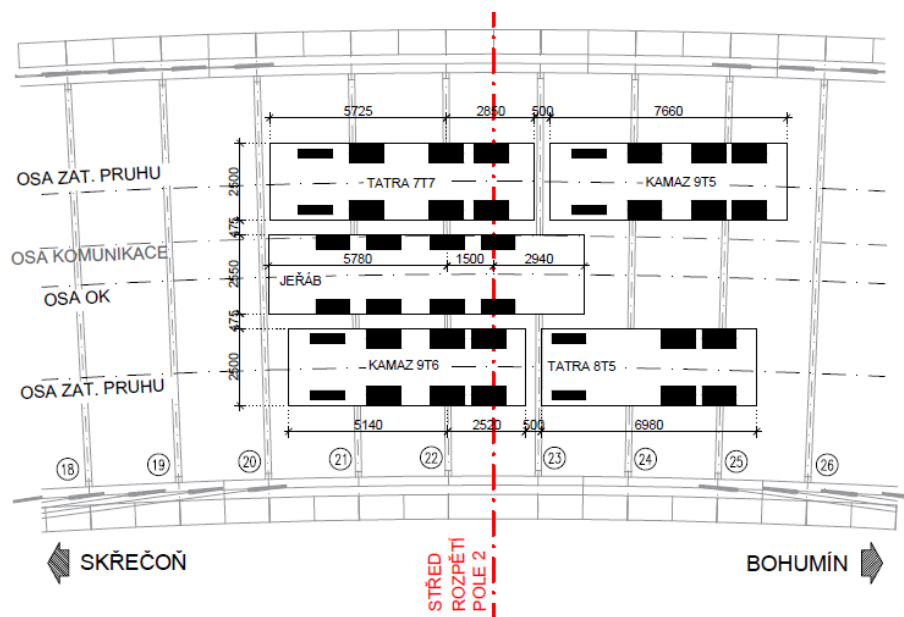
Schéma zatěžovacího stavu ZS1 a ZS6 – půdorys [11]
